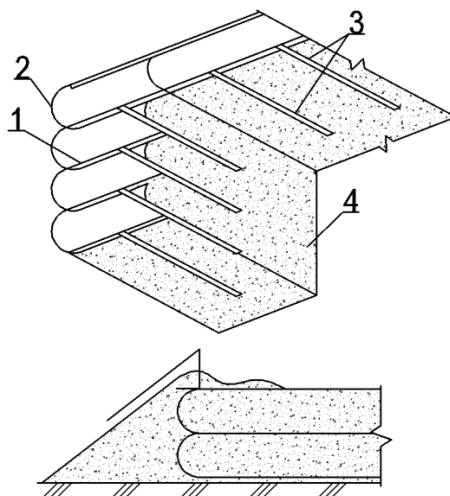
Армированный грунт со сборной металлической облицовкой:
